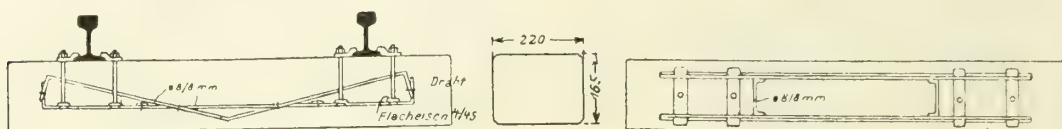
Kleinbahn-Eisenbeton-Schwelle von Voitel
